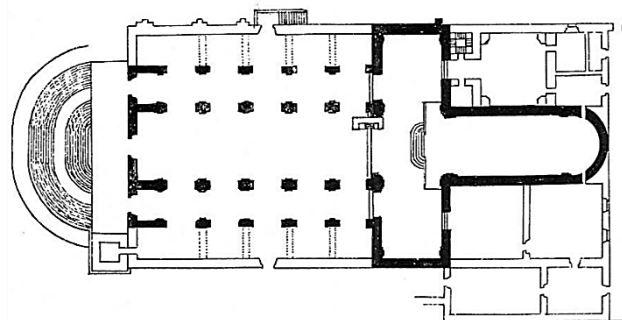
Pianta della Cattedrale Ottocentesca (1796)
